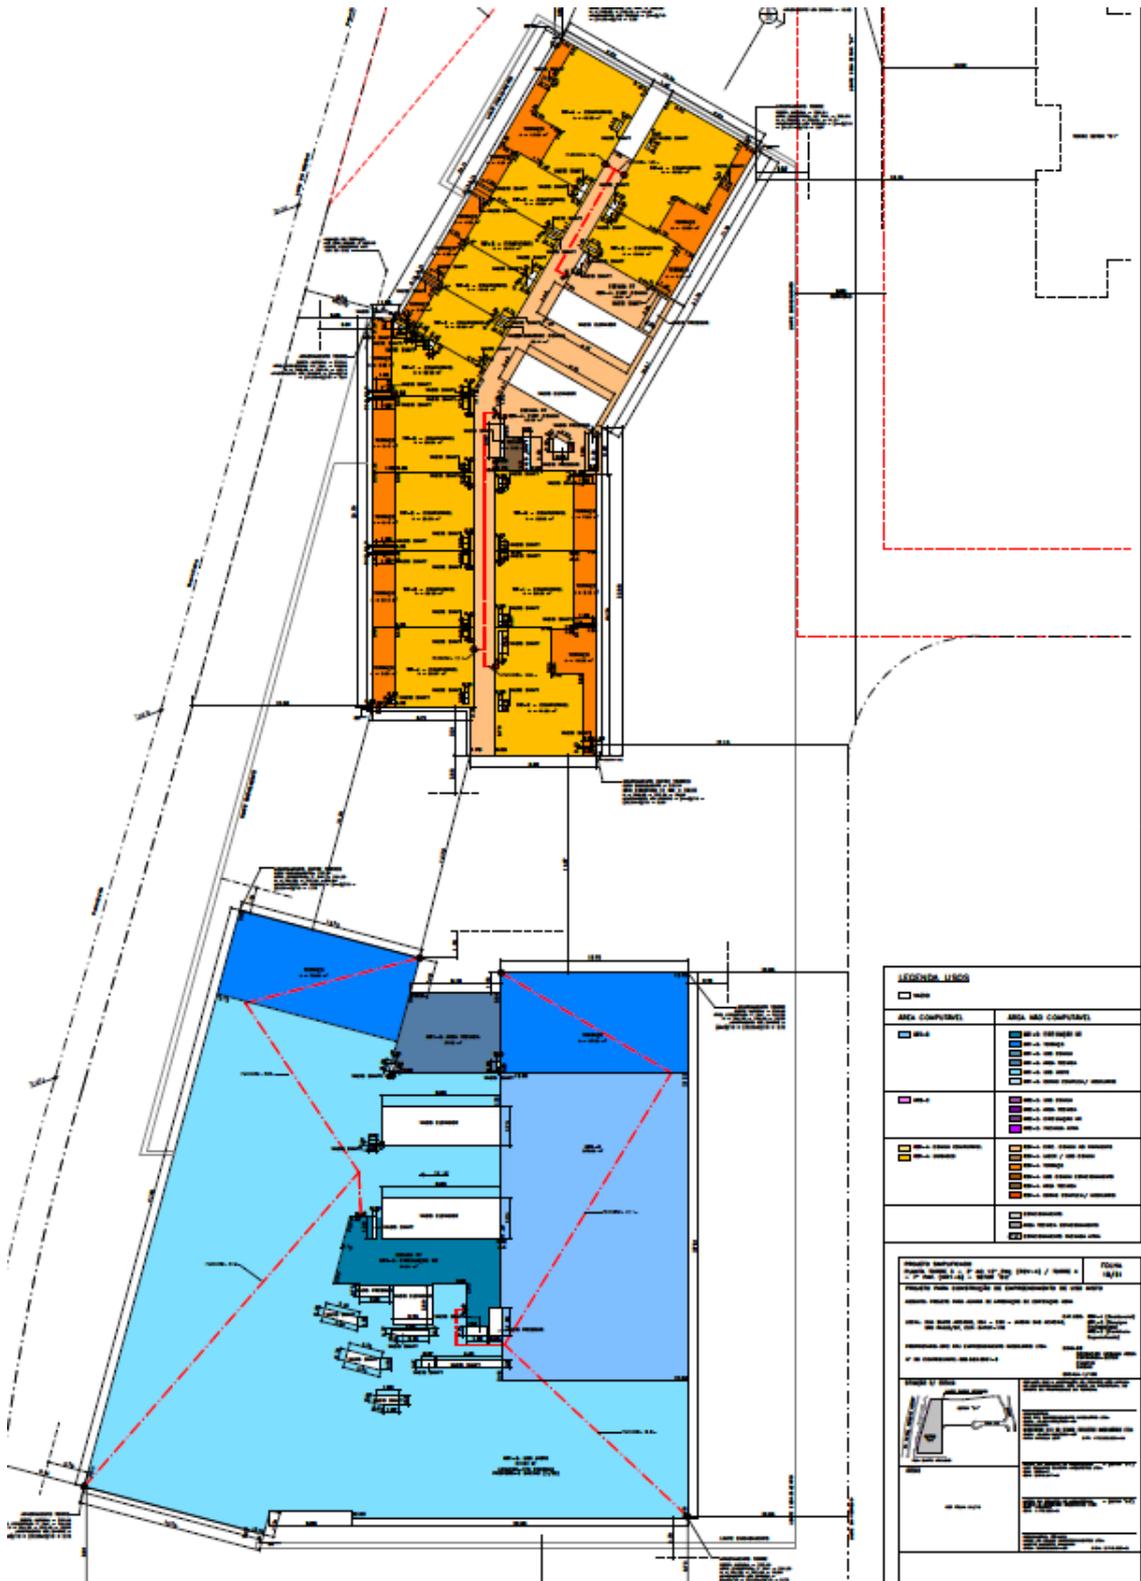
Torre 3 - 3º ao 12º pavimento. Torre 4 – 7º pavimento. Setor B2.
